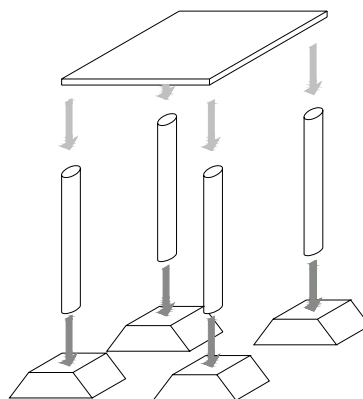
Lajes apoiando diretamente sobre pilares.
